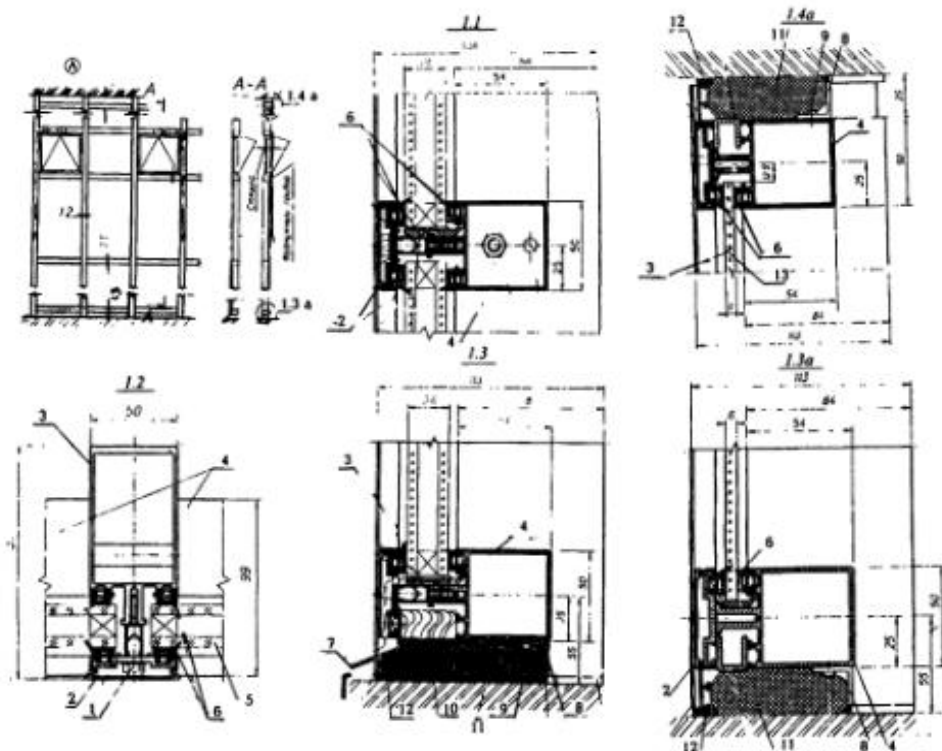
Витраж из алюминиевых профилей со стеклопакетом (система "Татпроф"): А - монтажная схема; 1 - самонарезной винт; 2 - нащельник; 3, 4 - вертикальный (3) и горизонтальный (4) импосты; 5 - стеклопакет; 6 - фиксирующие прокладки; 7 - металлический слив; 8 - обрамляющий уголок; 9 - винт; 10 - деревянный брусок 16х32 мм; 11 - утеплитель; 12 - герметизация зазора; 13 - стекло
